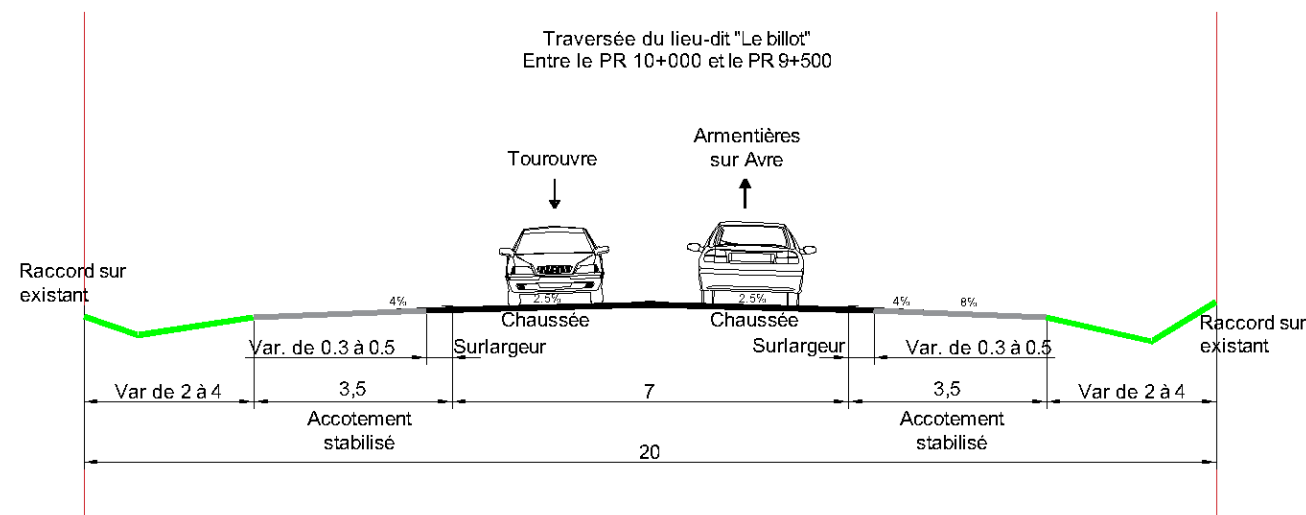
Profils en travers type – section 2 (source: SEGIC)
